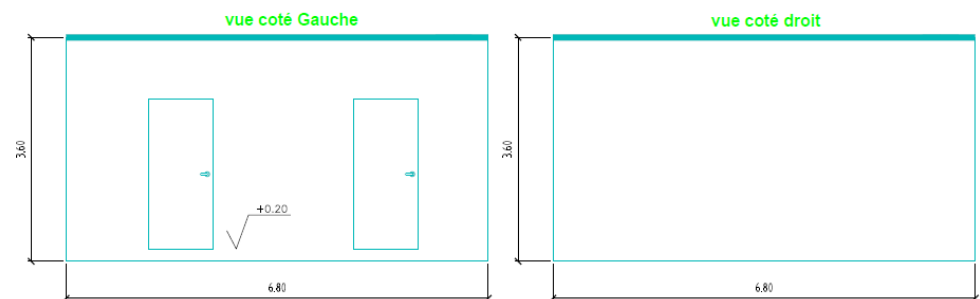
Coupe du bâtiment du poste de Transformation et de livraison (source: REDEN)
